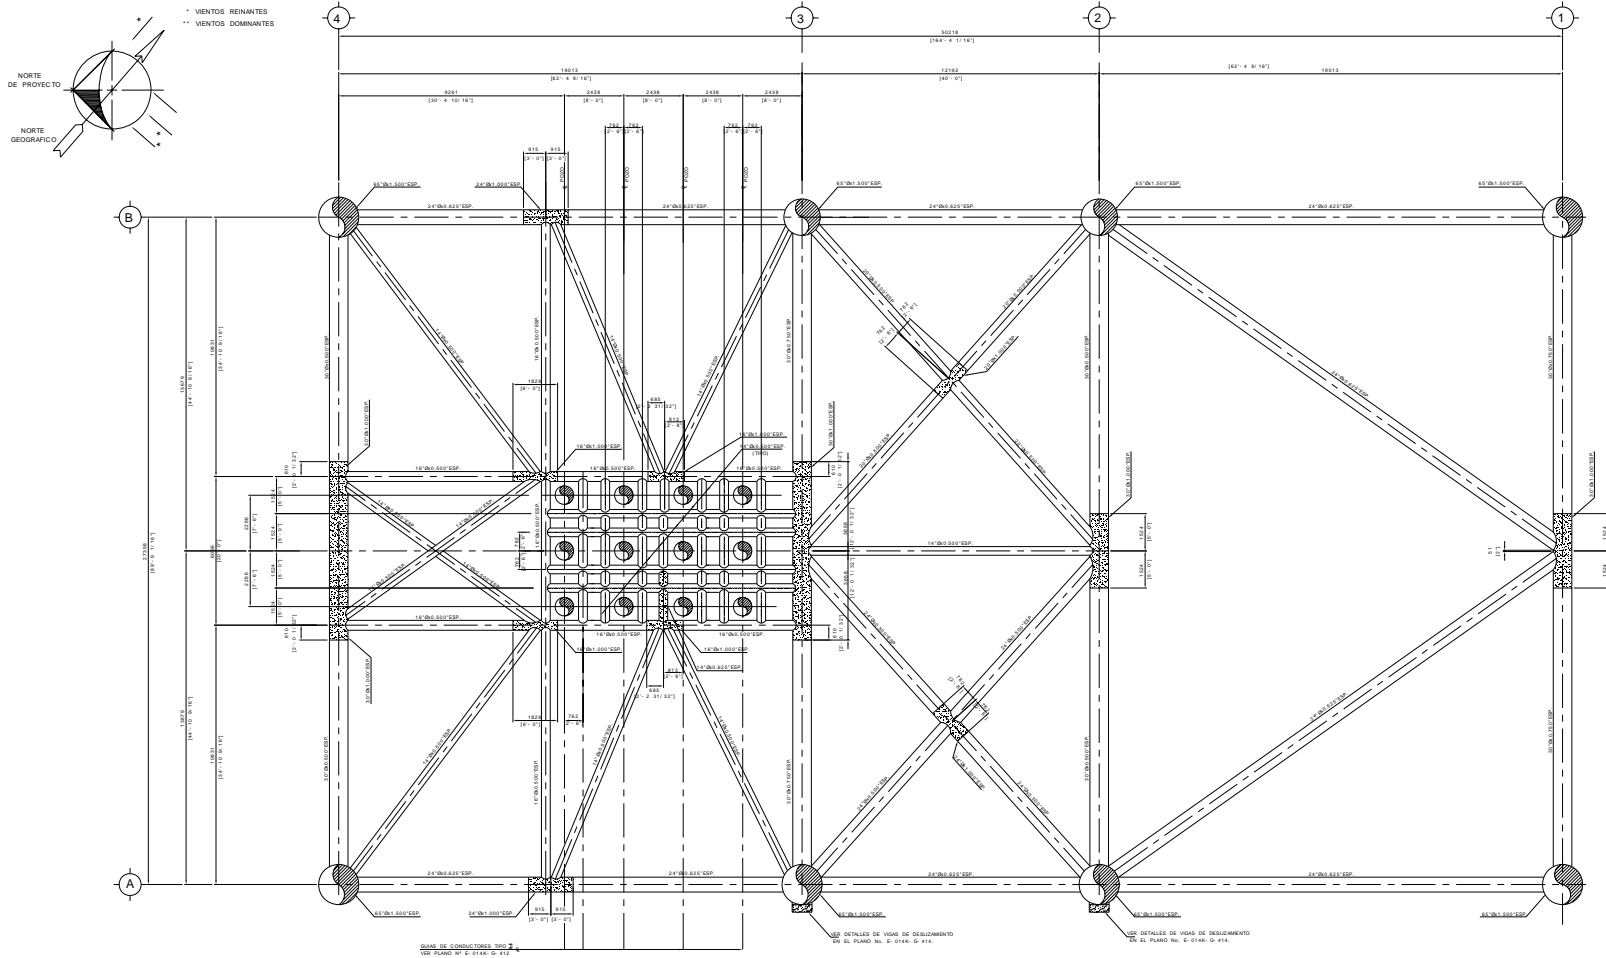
Planta en elevación (-) 44.000 m (144'-4 5/16").
